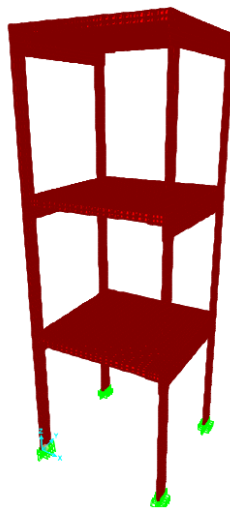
Modelo de elementos sólidos utilizado no cálculo da estrutura em SAP2000.
